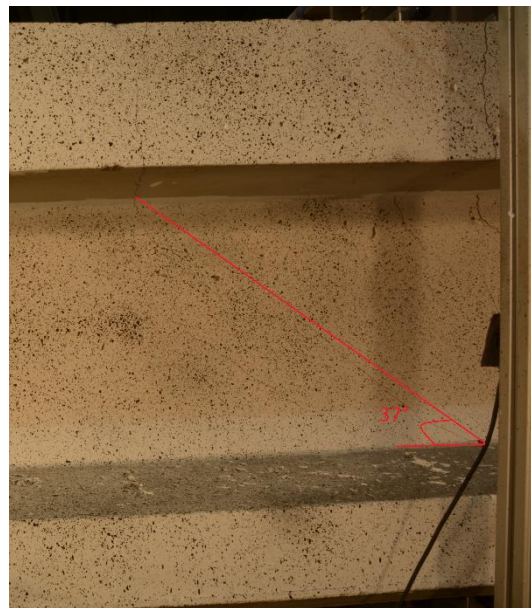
Ángulo de fisuración en la viga 4
